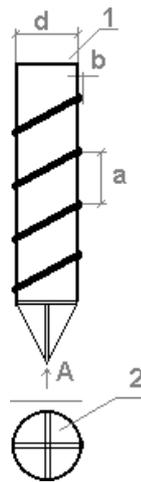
Принципиальная схема бурозавинчивающейся сваи
